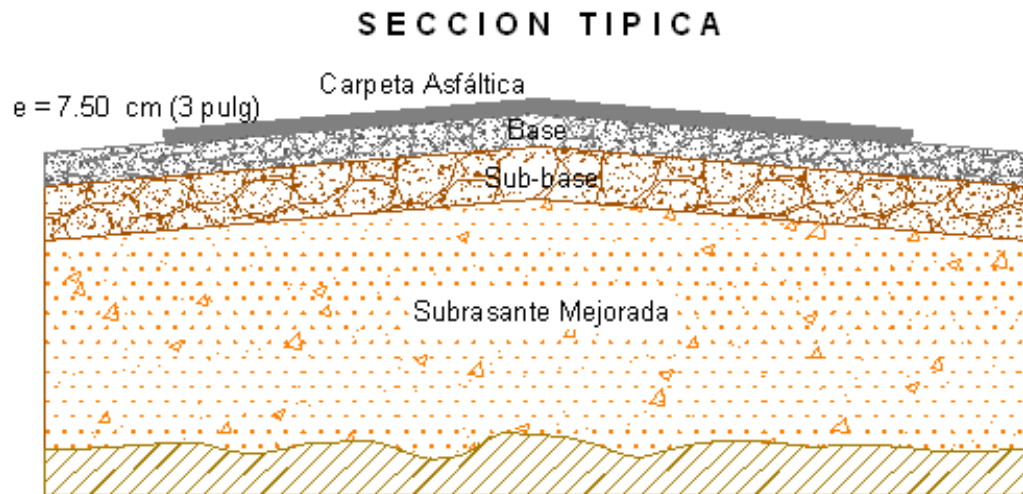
Acabado de Carpeta de rodadura (Pavimento)
